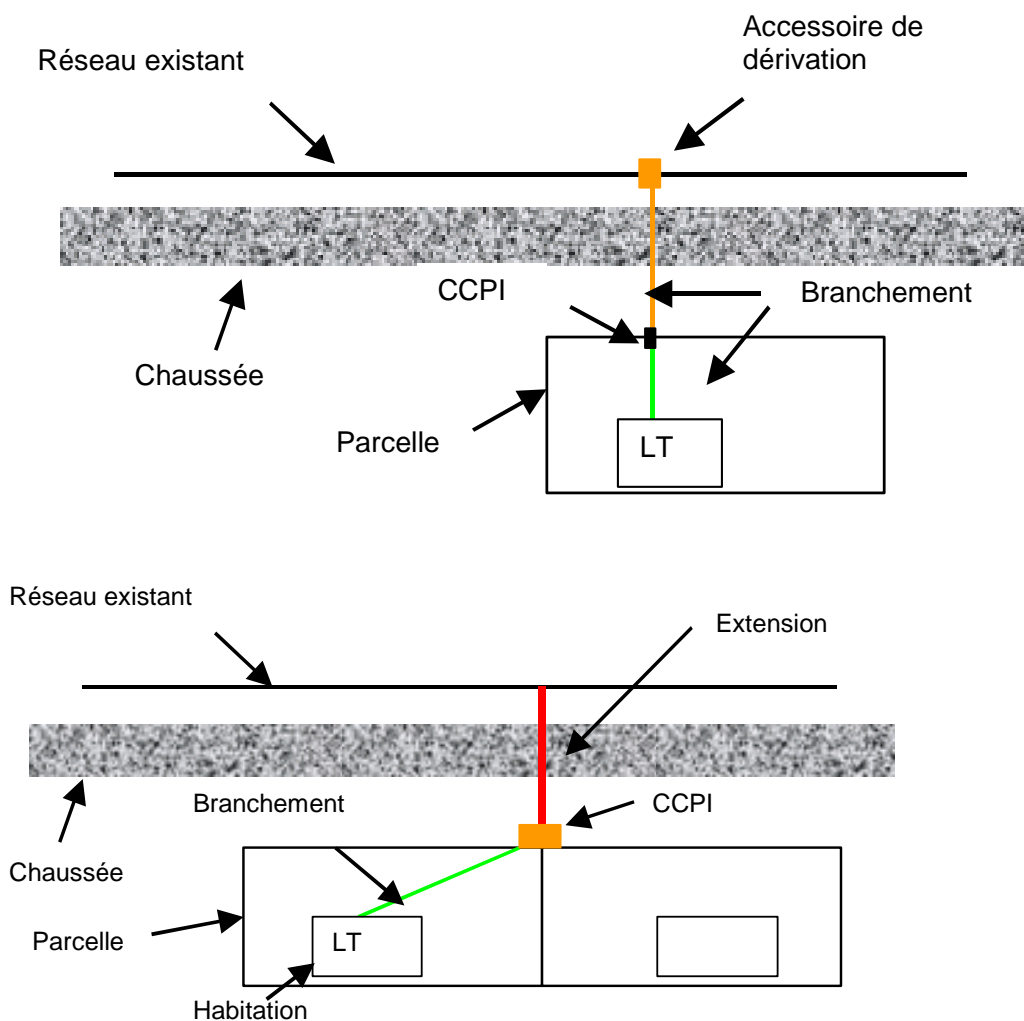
Raccordement individuel BT > 36 kVA avec traversée de chaussée
